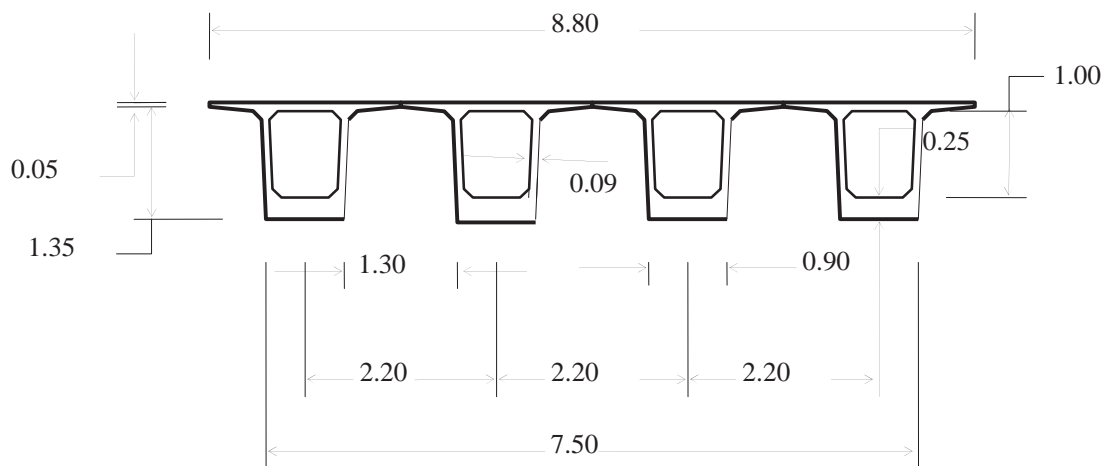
losas apoyadas en sección tipo I y sección tipo cajón
